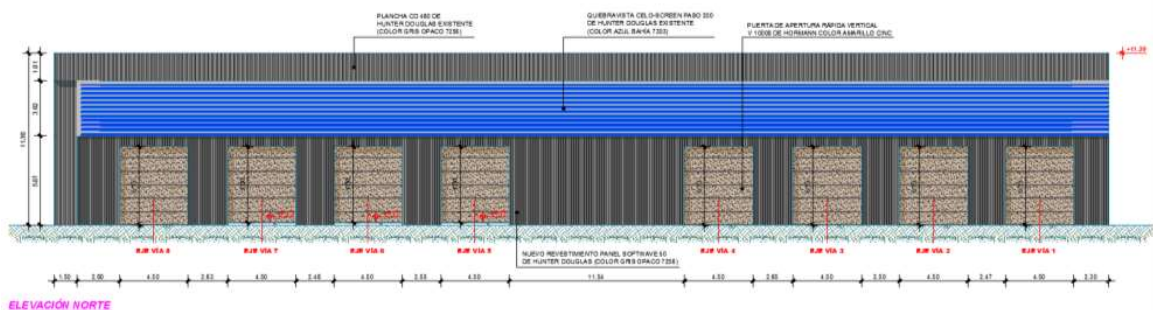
Fachada Norte Projetada do Parque Material e Oficinas
